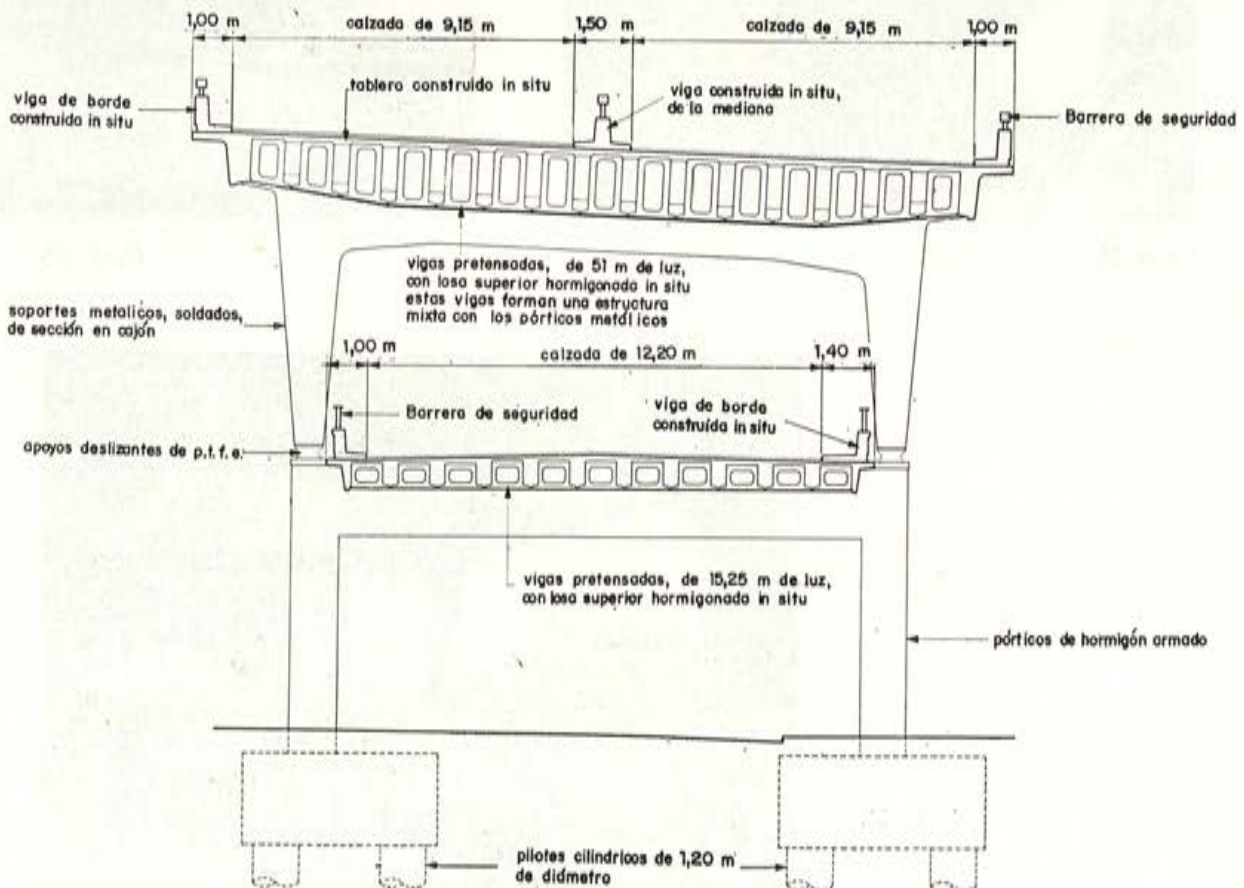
Paso elevado de Westway, en Londres. Sección transversal de la estructura con tablero doble.
